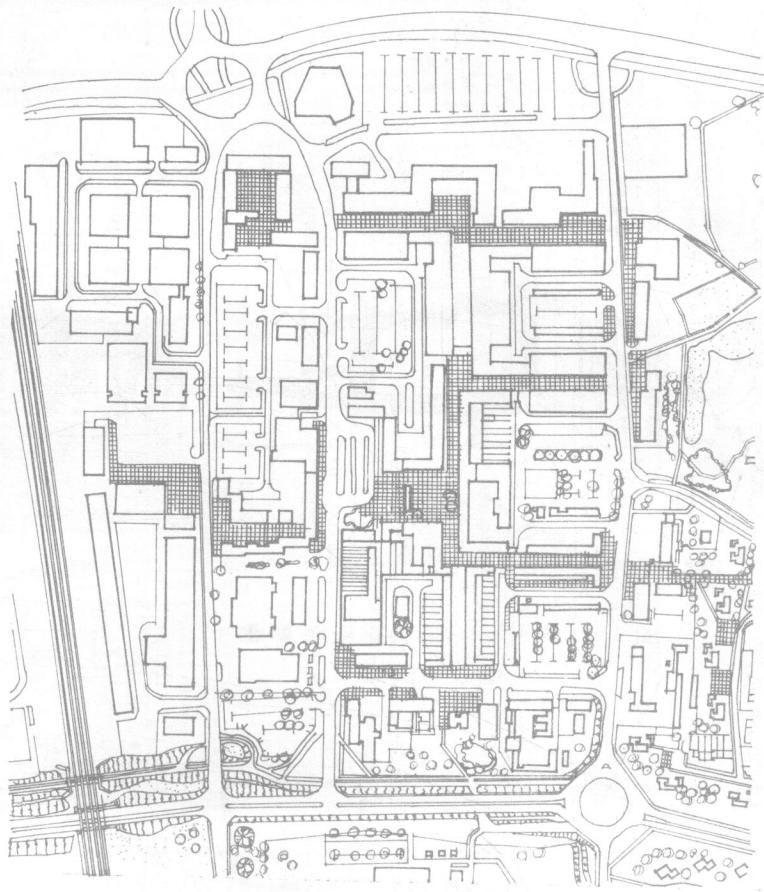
15. 英国斯特文内奇(Steveage)中心商业区平面图
